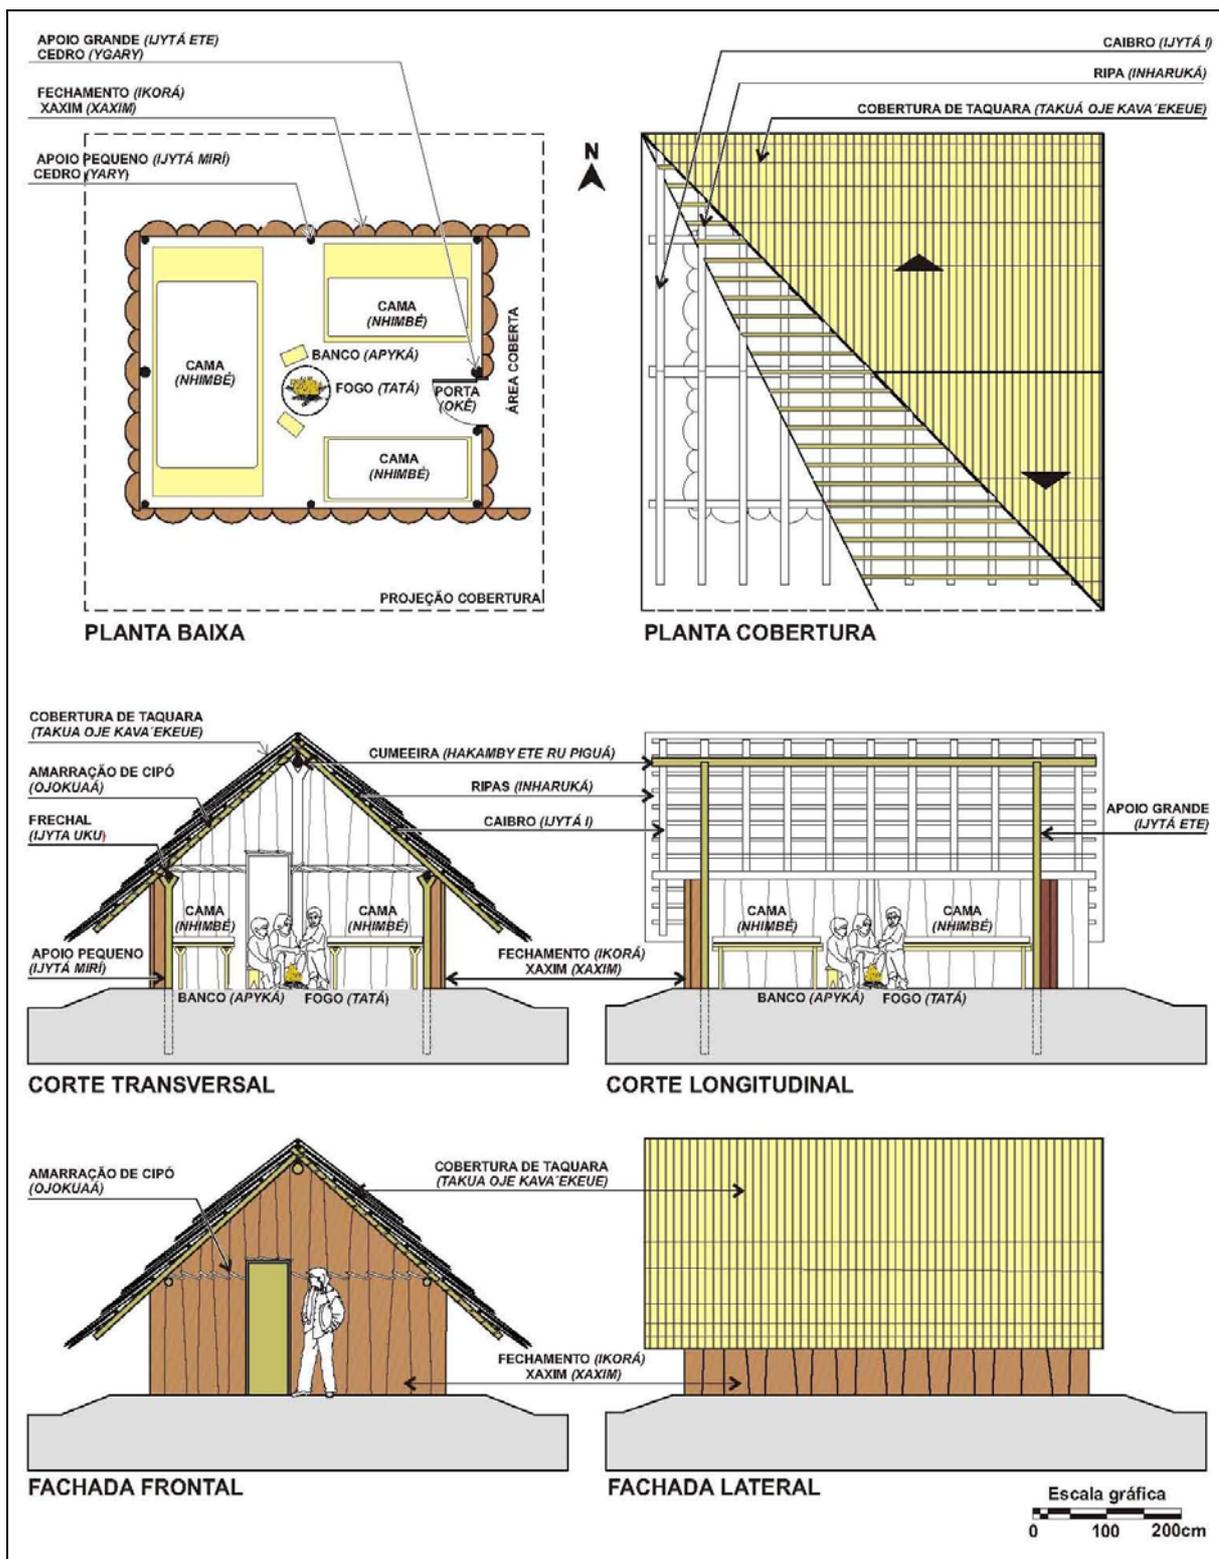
plantas, cortes e fachadas da tipologia da casa de xaxim.
